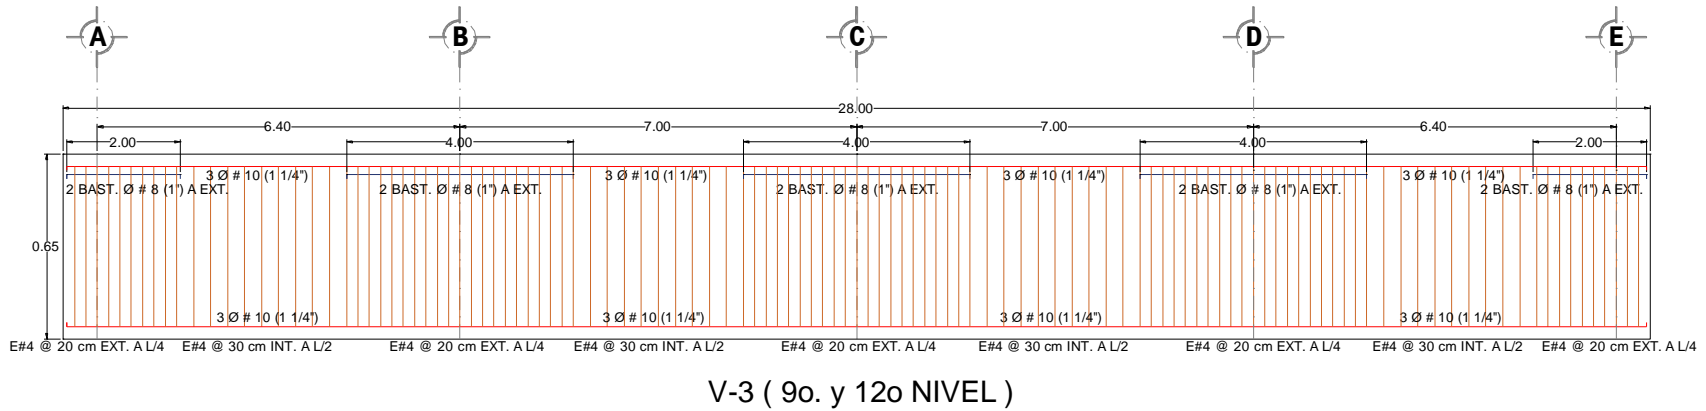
Detallado de armado de vigas del marco de 12 niveles con base a secciones gruesas.
